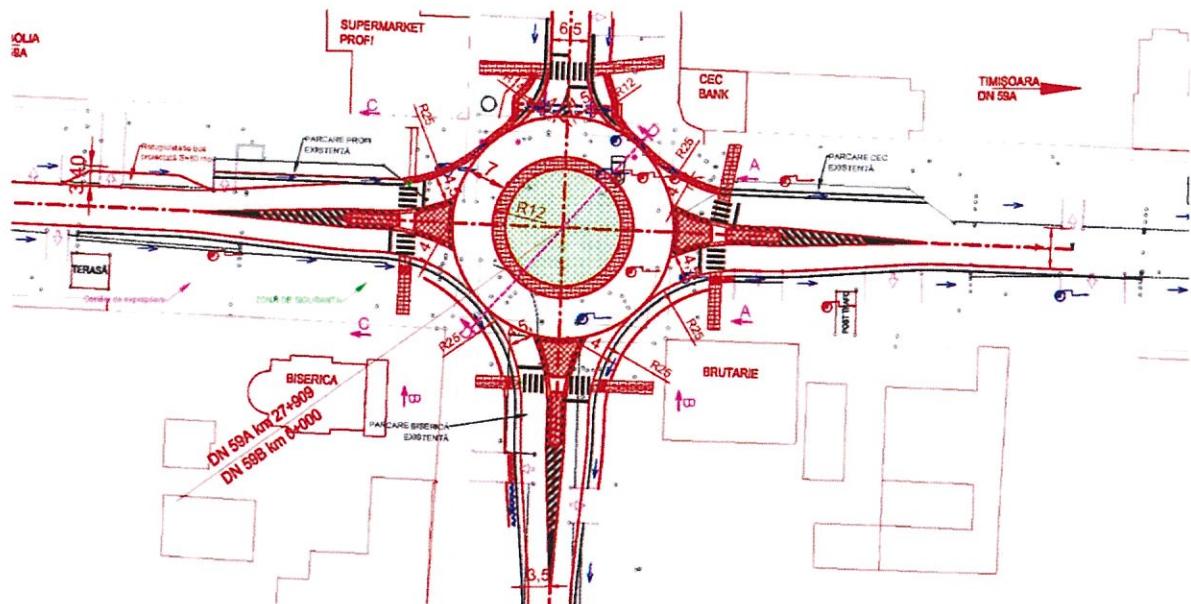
PLAN DE SITUAȚIE VARIANTA PROPUȘĂ
